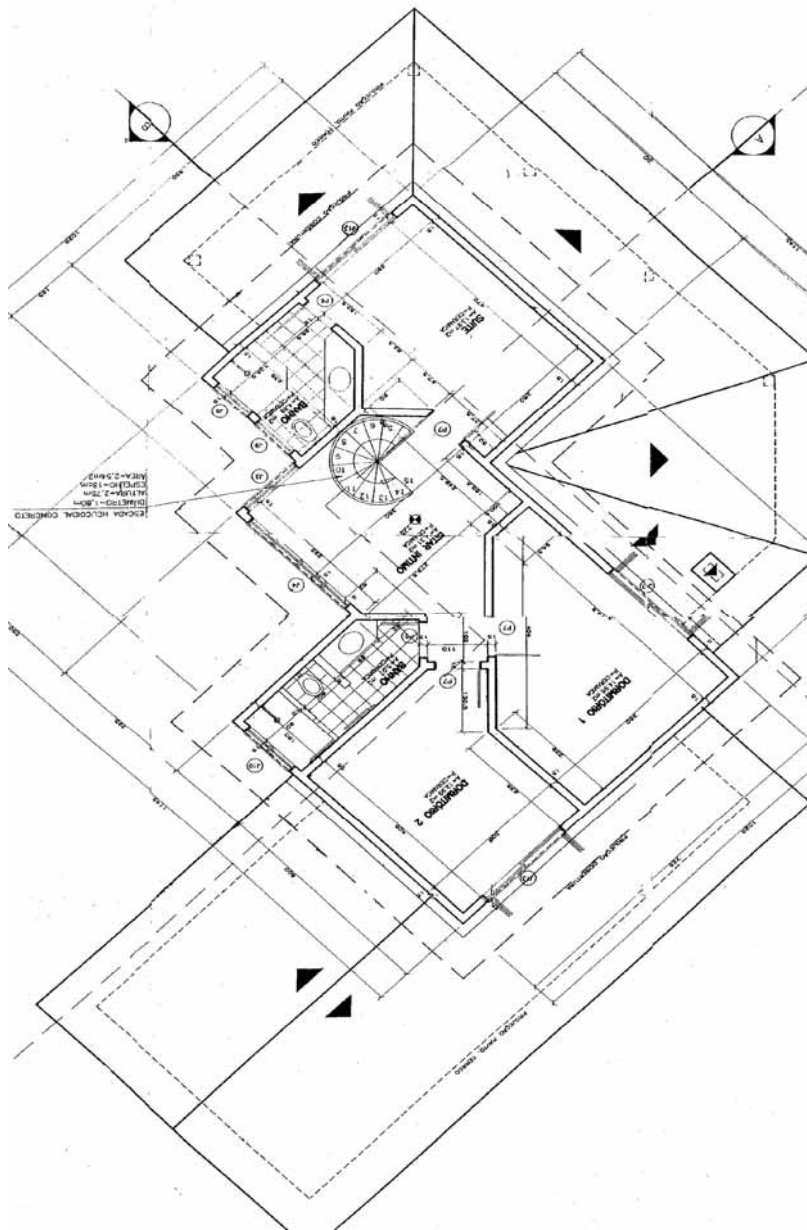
Projeto Estudo de Caso 1 - Planta Baixa Pavimento Superior.
